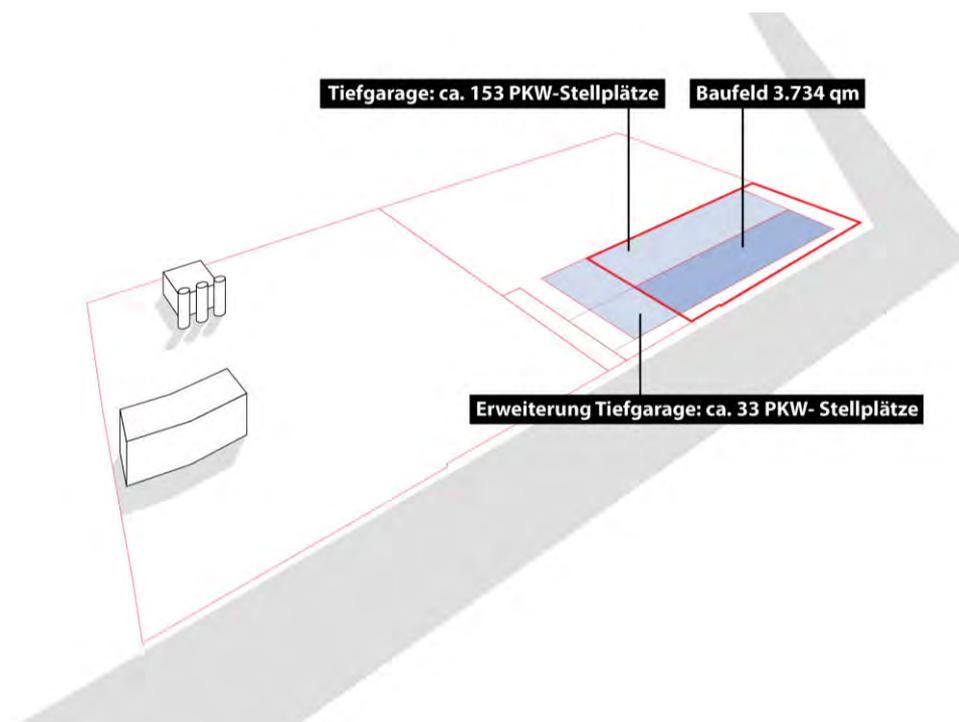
Strukturierung Baufeld Kleingewerbe
